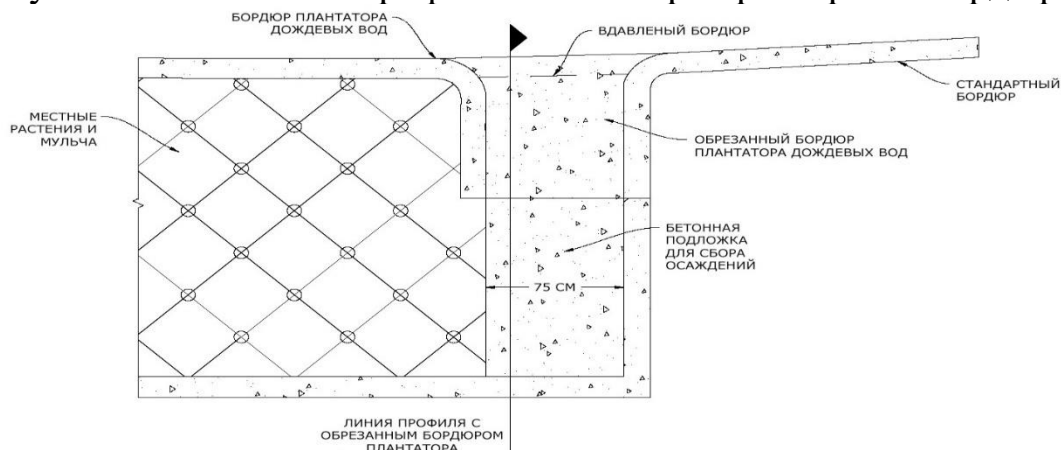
Типовой профиль плантатора при обрезке бордюра (вид сверху)
